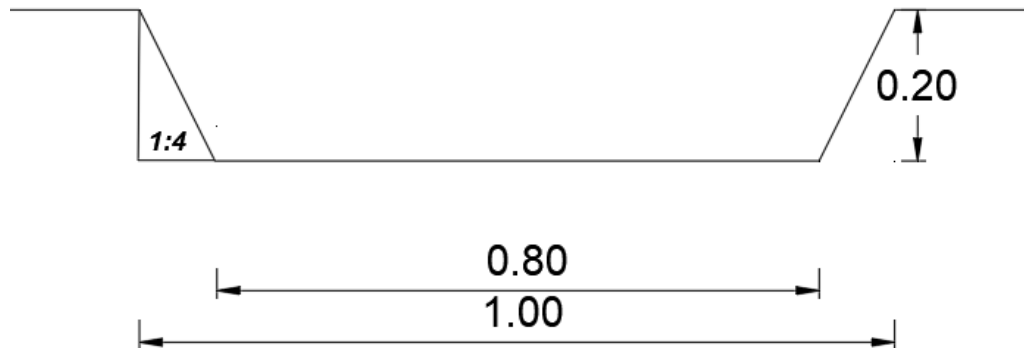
Esquema Vertedero Trapezoidal de Captación
